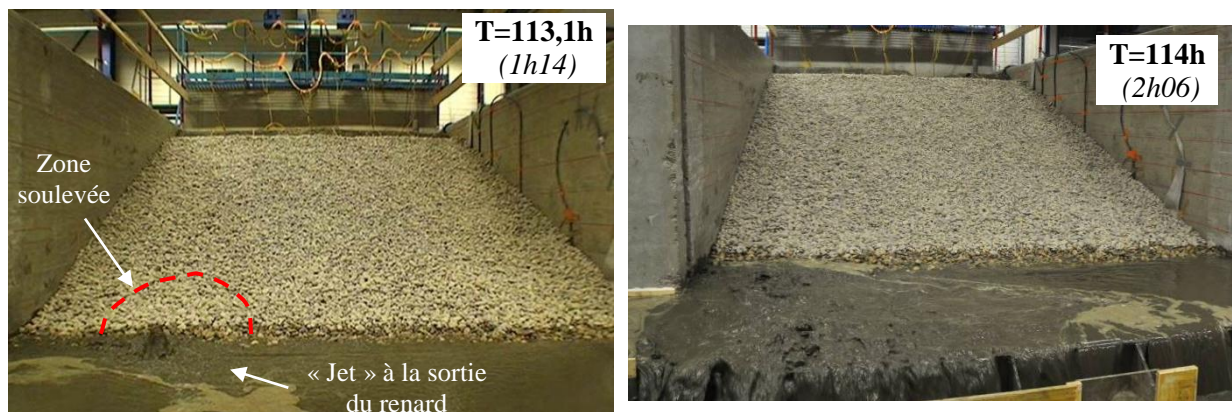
Soulèvement du géotextile et « jet » d'eau provenant du conduit.
